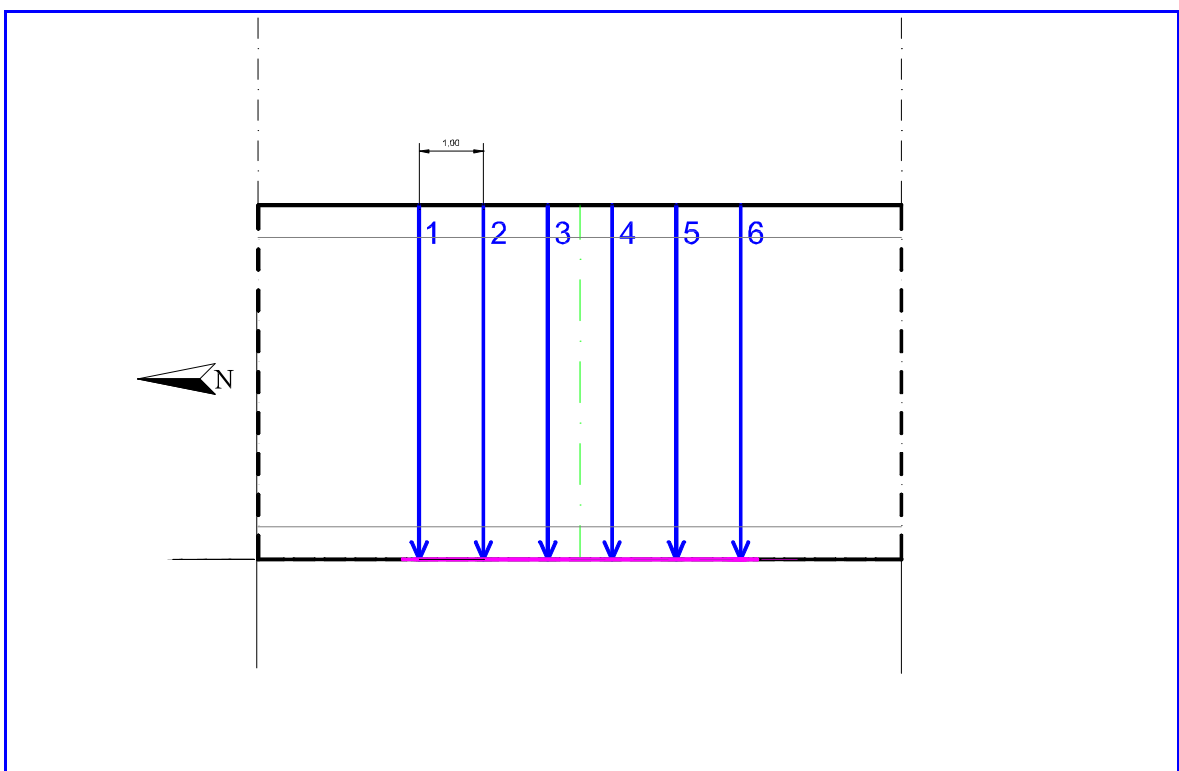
SP 14 - km 10+130 - Pianta dell'area di prova
